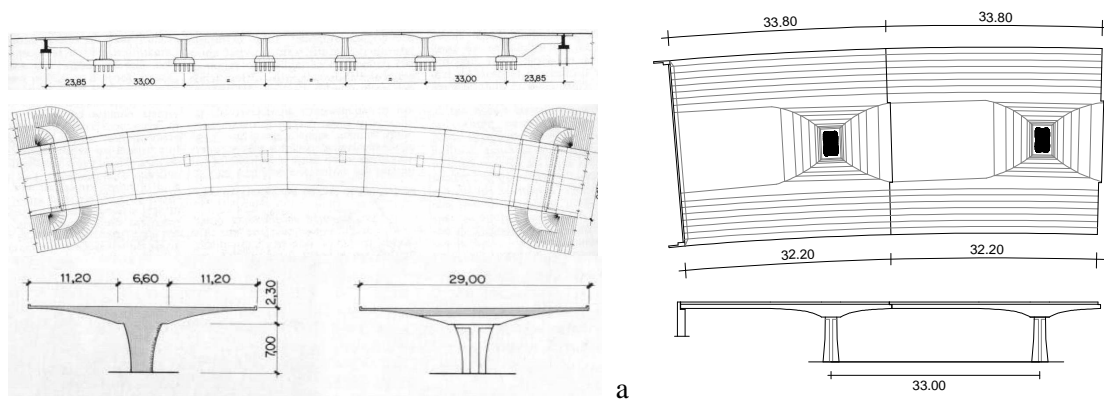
Il ponte sulla laguna Ruwais. a) Pianta, prospetto e sezioni. b) Avanzamento delle stampelle.
